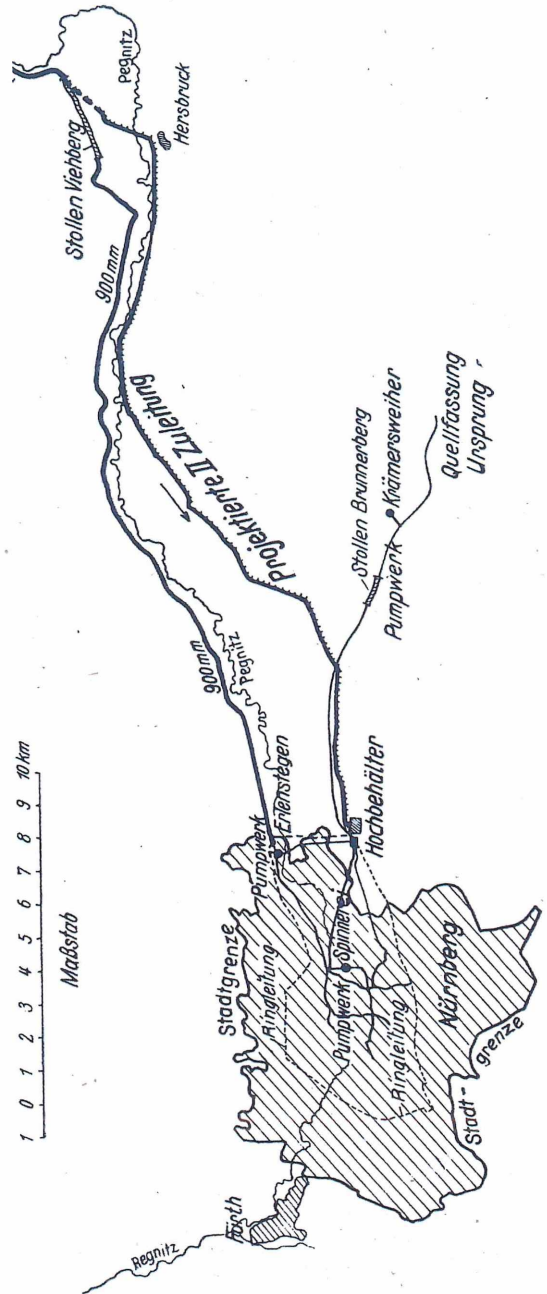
Lageplan für die zweite Rannaleitung (Krauß 1930, 1156 – Ausschnitt)
